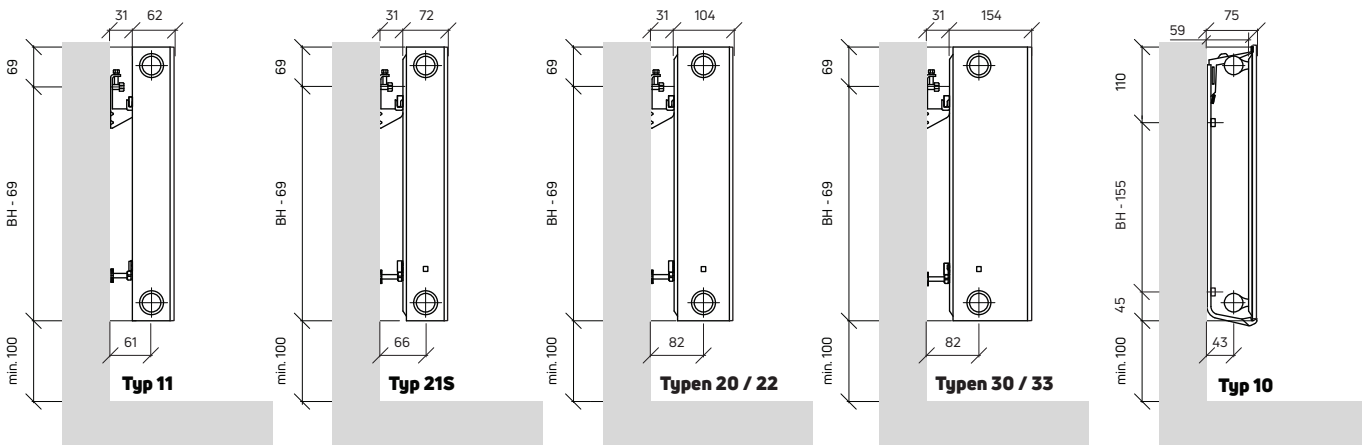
Montagemaße für Plan Compact und Ramo Compact mit Befestigungslaschen
